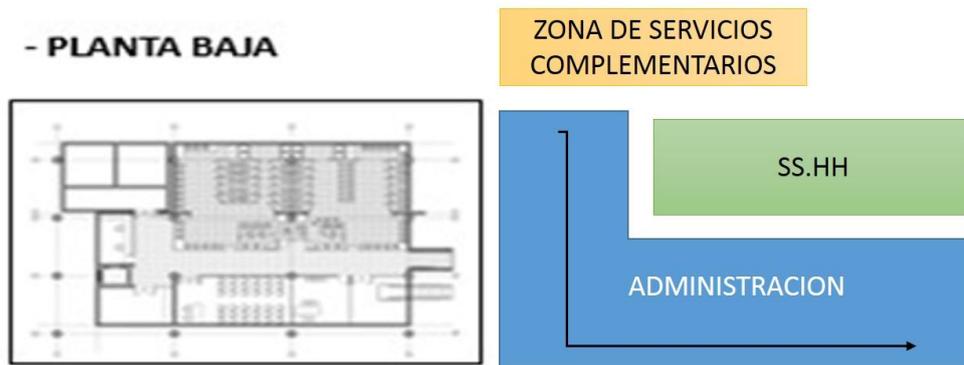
Caso análogo n° 2 Primera planta Circulación.
